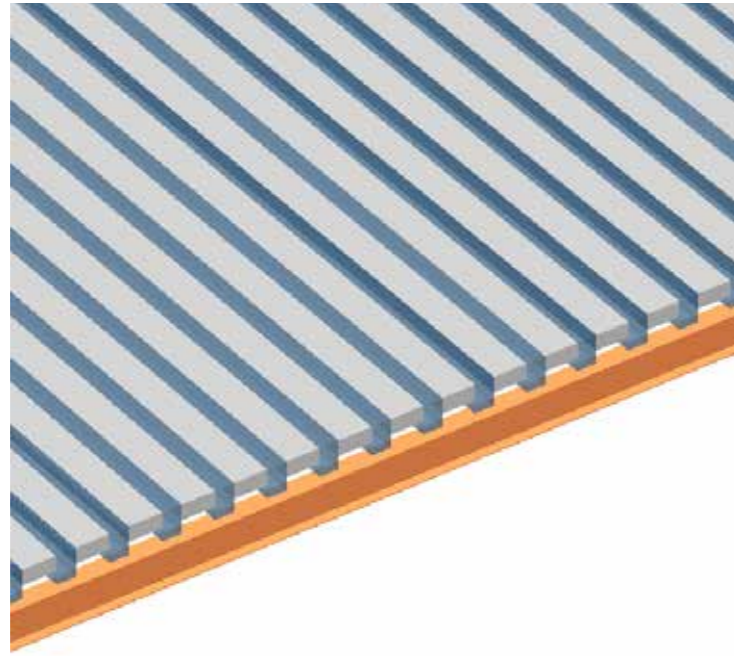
Фрагмент расчетной модели опирания перекрытия с профилированным настилом на стальную балку. Синим цветом – трехслойная плита внутри гофра, серым цветом – двухслойная плита между гофрами (слои плиты условно не показаны)
